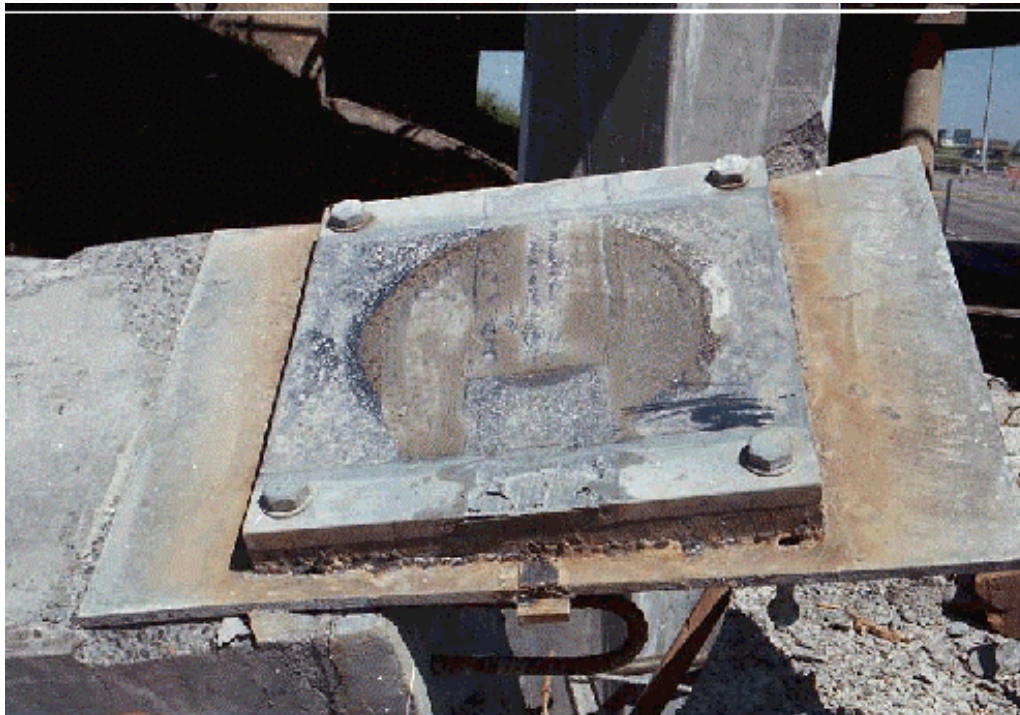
Dessous de la plaque de la poutre 1 à la pile 2 (photo 330.2.20)
